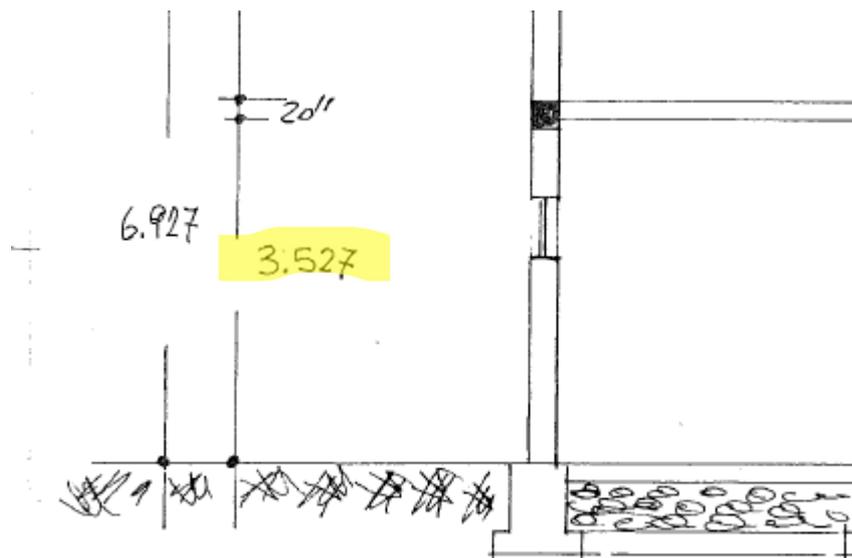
stralcio DIA - prot. 4727 del 21/06/2005 con indicate le dimensioni in sezione del piano terra.
